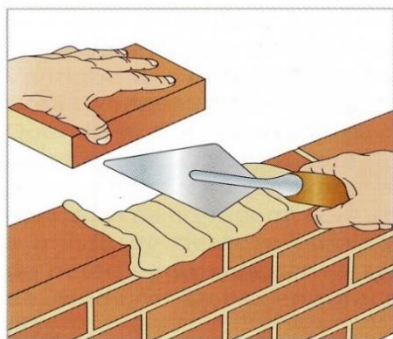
Exemplos de argamassa de assentamento (38)
